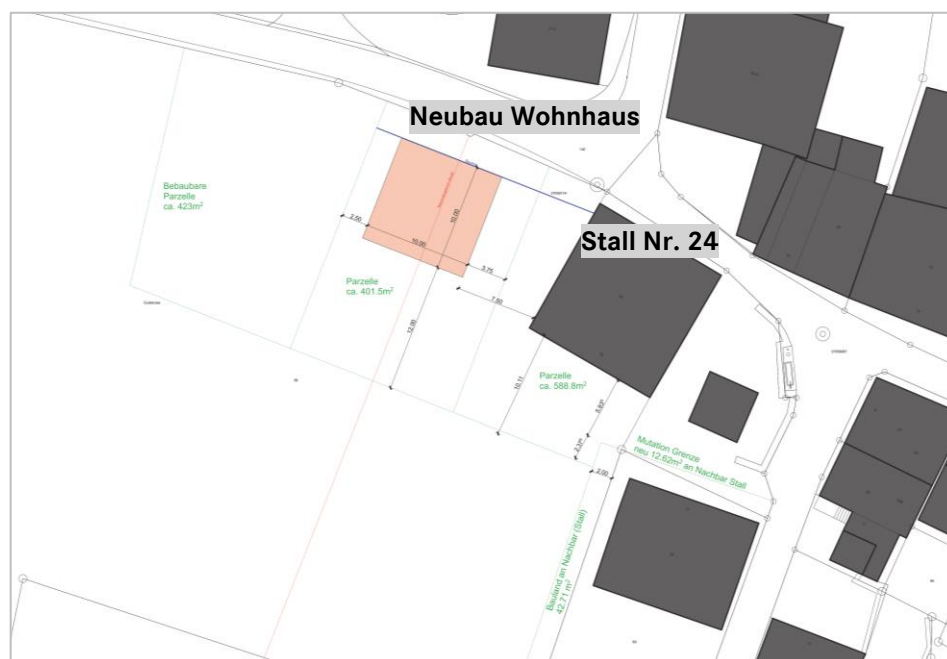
Gebiet Custanzas mit ortsbildprägenden Bauten und geplantem Neubau Wohnhaus in der 1. Etappe.
